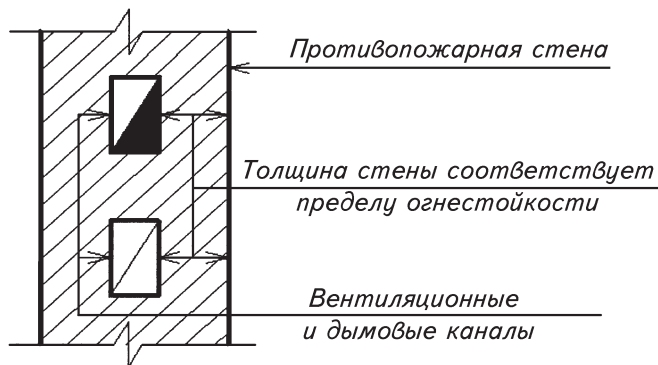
Устройство вентиляционных и дымовых каналов в противопожарной стене
